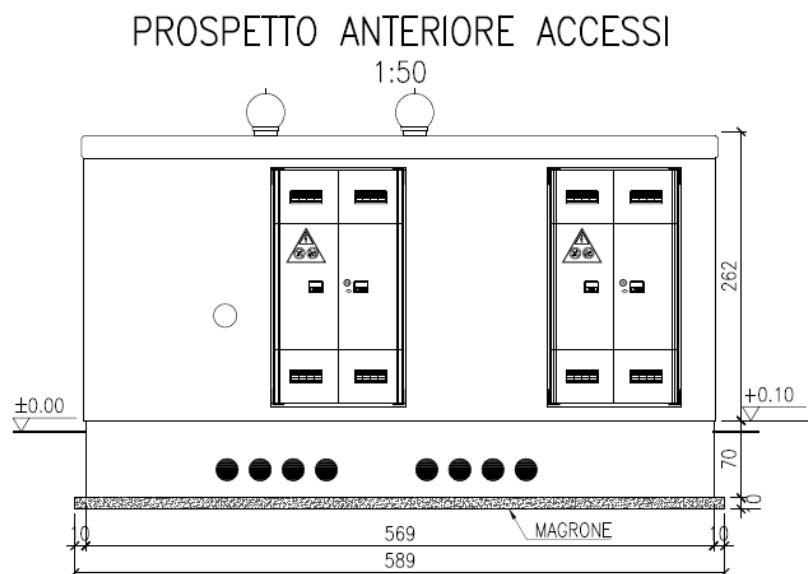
Prospetto frontale cabina di consegna POD-Utente
